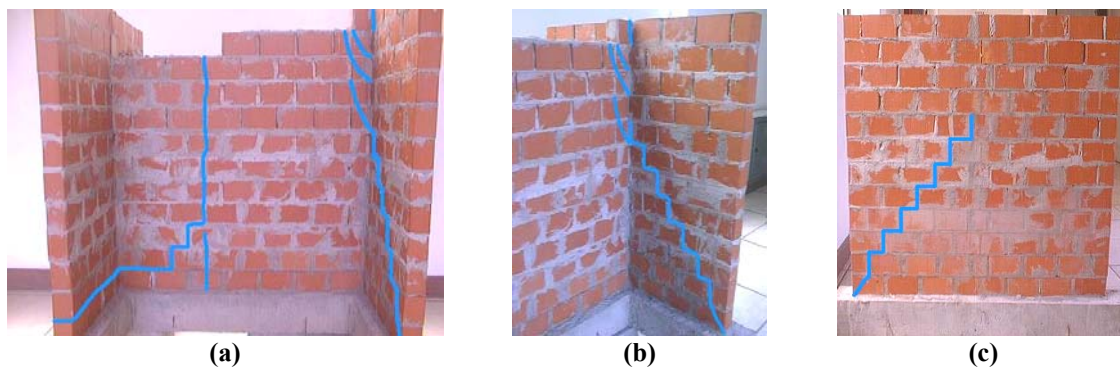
Forma de ruptura e fissuração do painel
